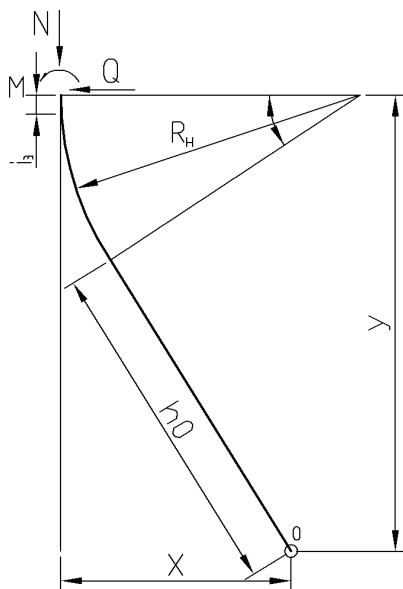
Схема работы стойки металлической арочной трехзвеневой крепи.
